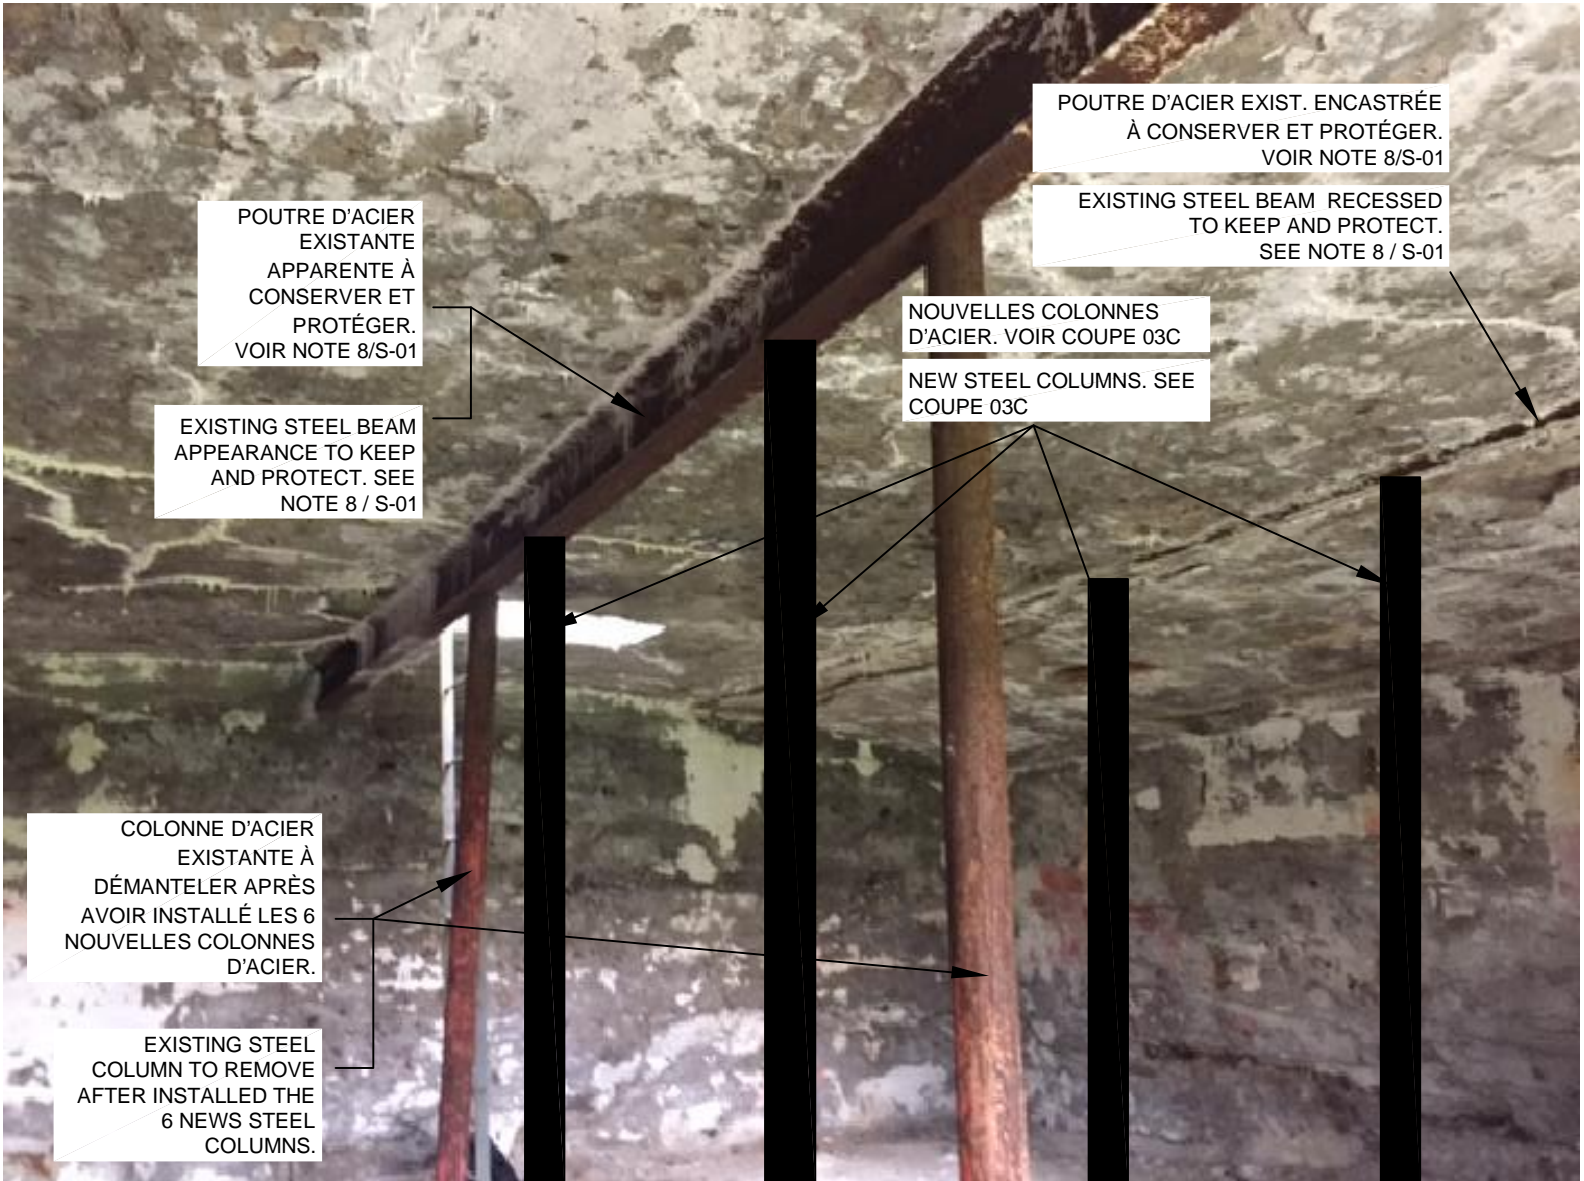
DALLE DE TOIT INTÉRIEURE ET COLONNES EXISTANTES
